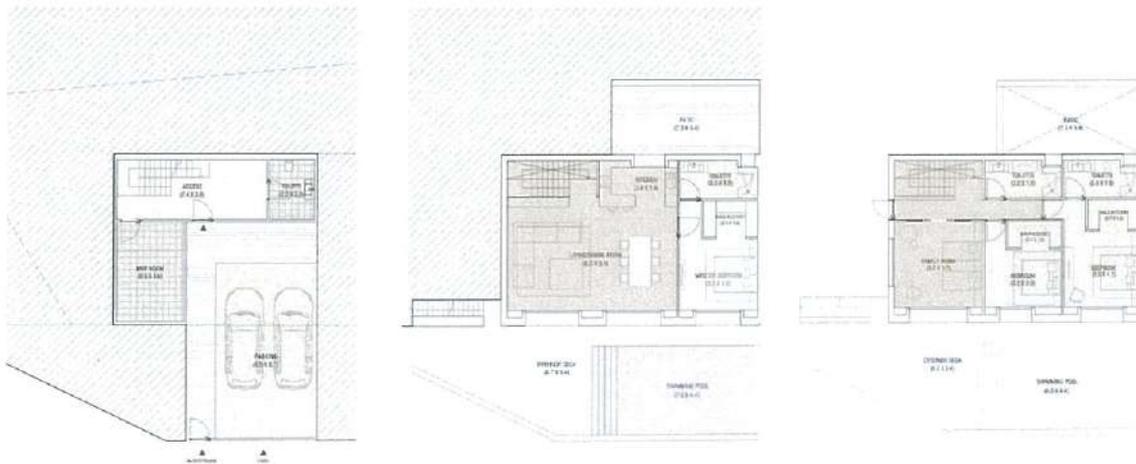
Plani i parkimit, katit përdhe dhe katit të parë të Vilës B
